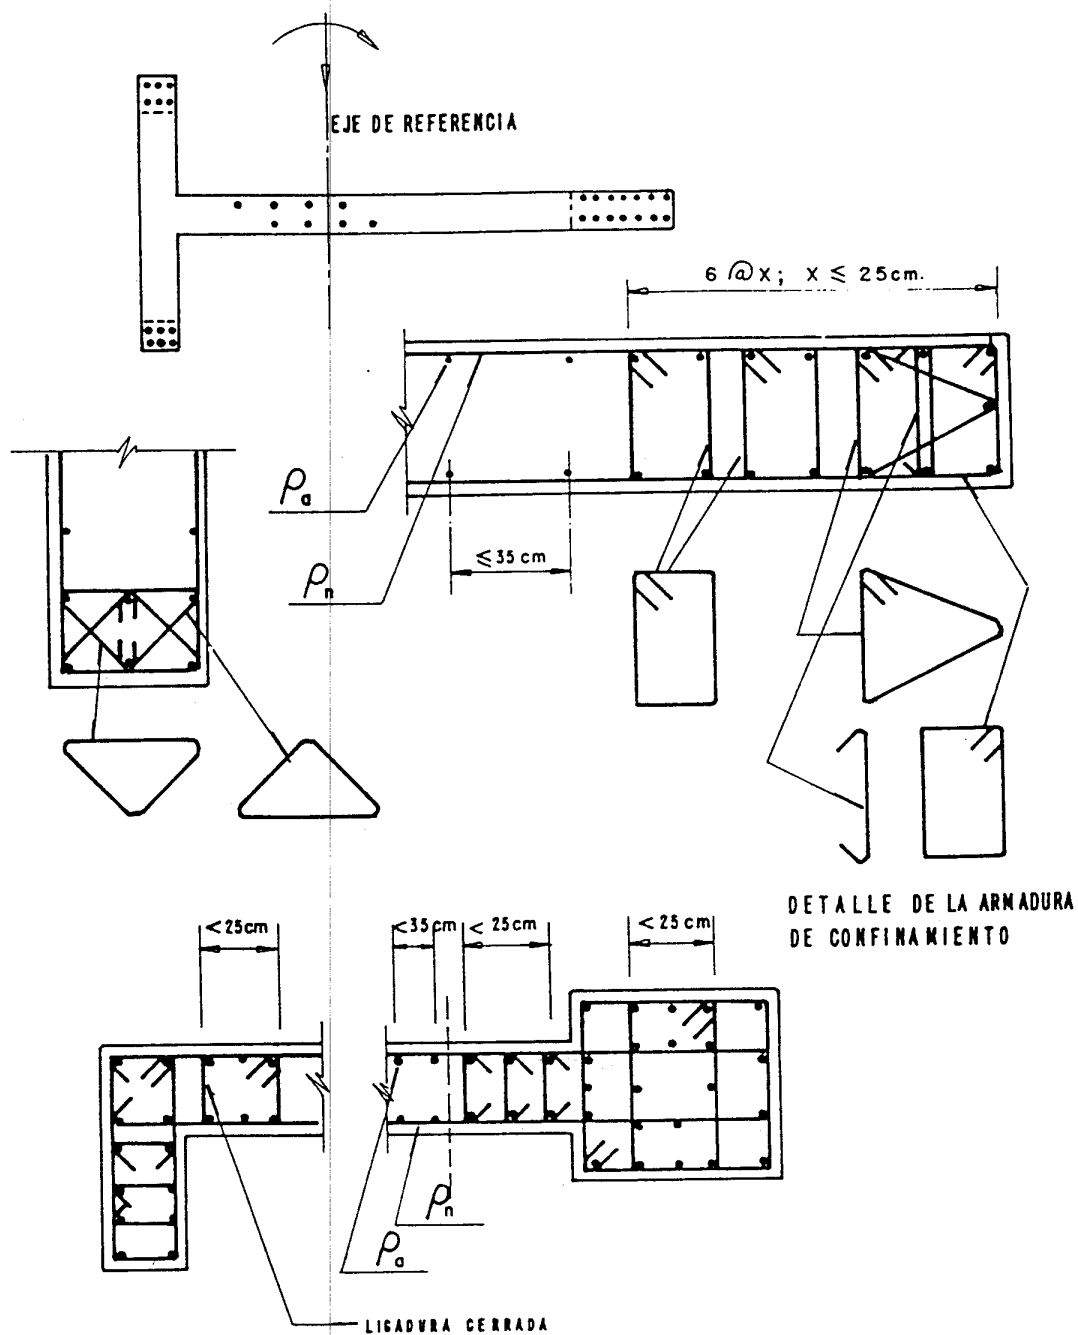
EJEMPLOS DE LA DISPOSICION DE LA ARMADURA EN UN MURO ESTRUCTURAL (NIVEL DISEÑO 3)
